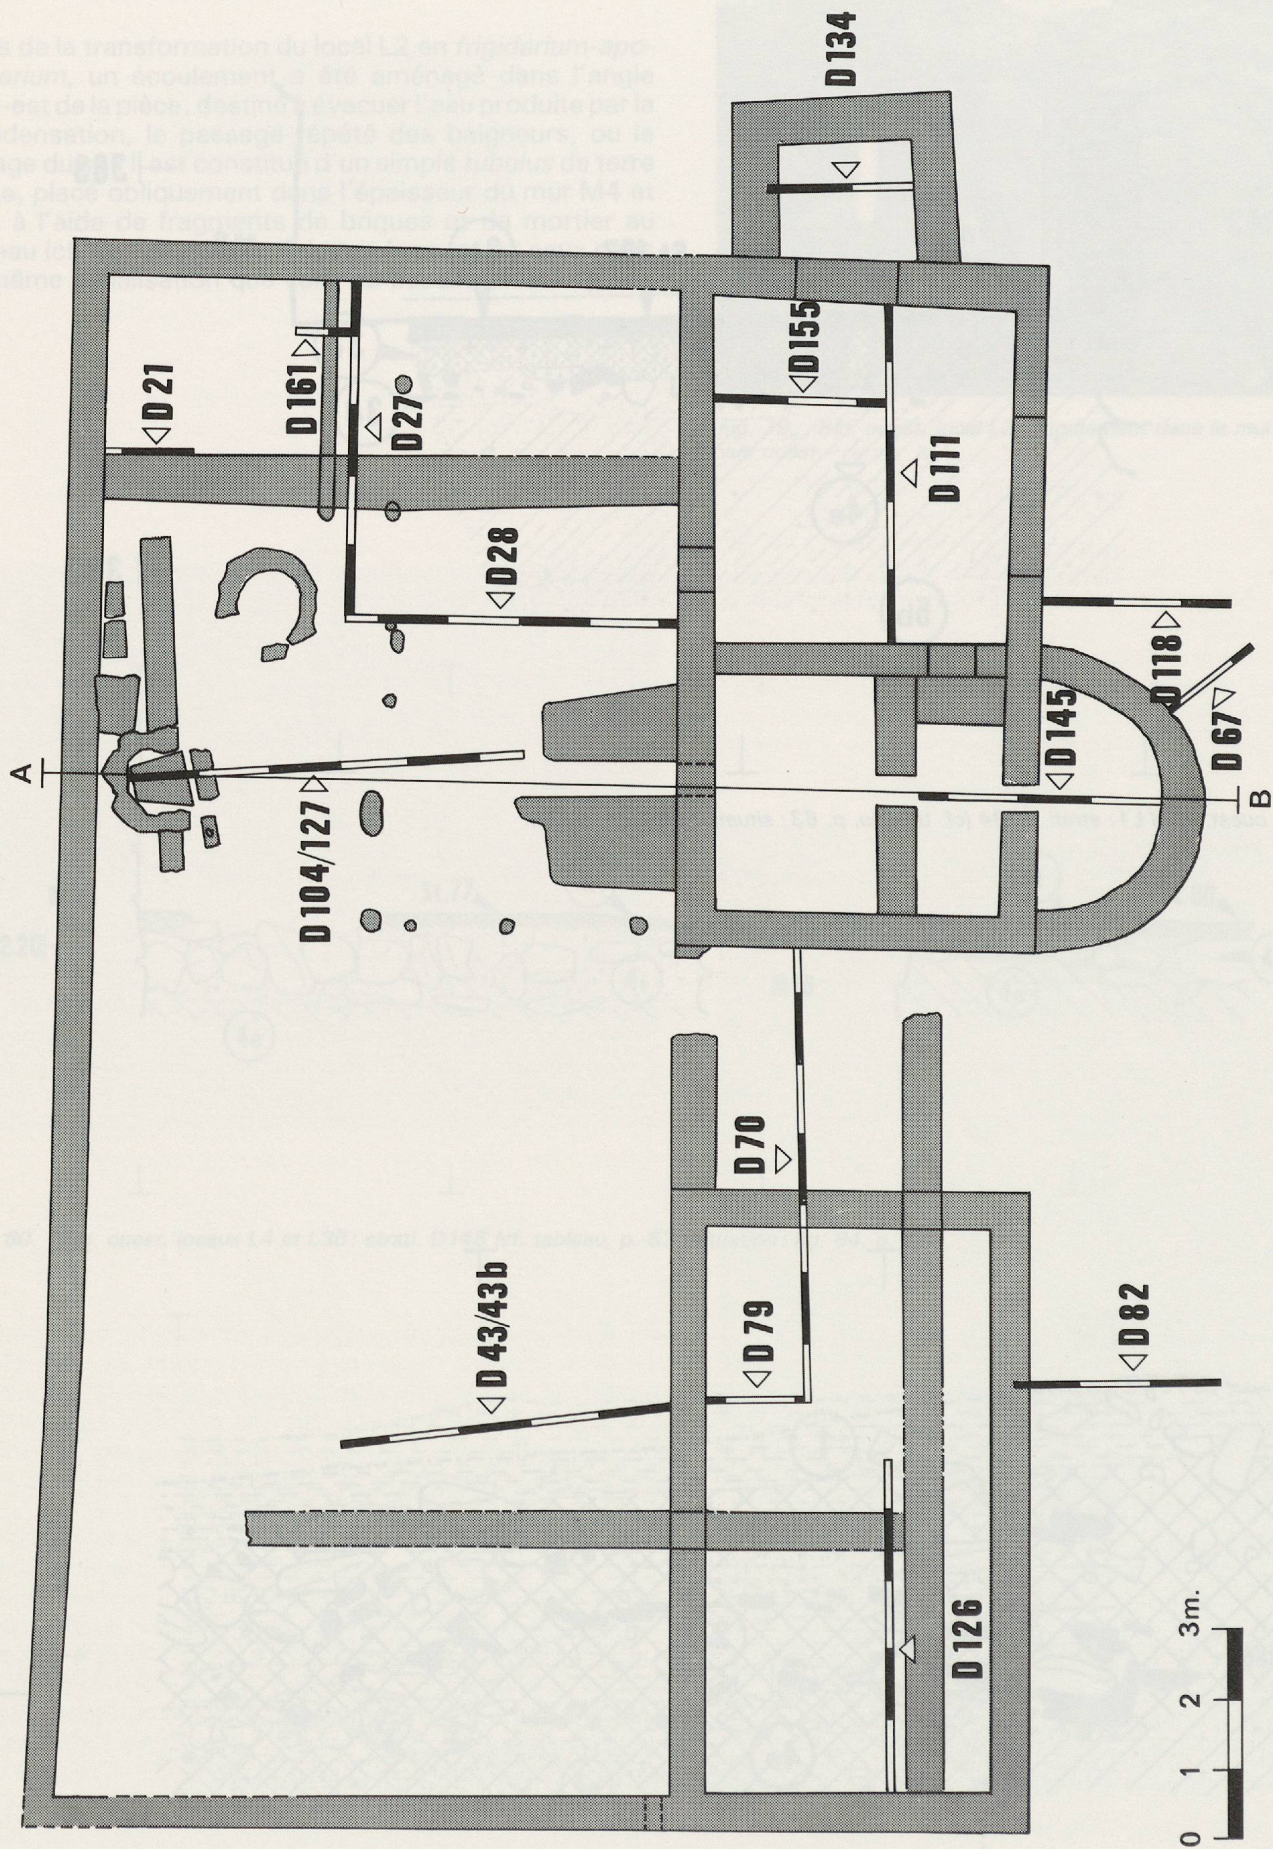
Bât. ouest: plan de situation des coupes figurées.
